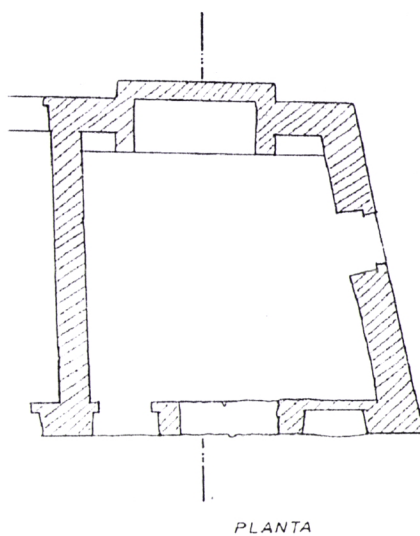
Moura, Castelo, levantamento de habitação do Castelo, planta da casa "medieval", 1996 (CMM)
